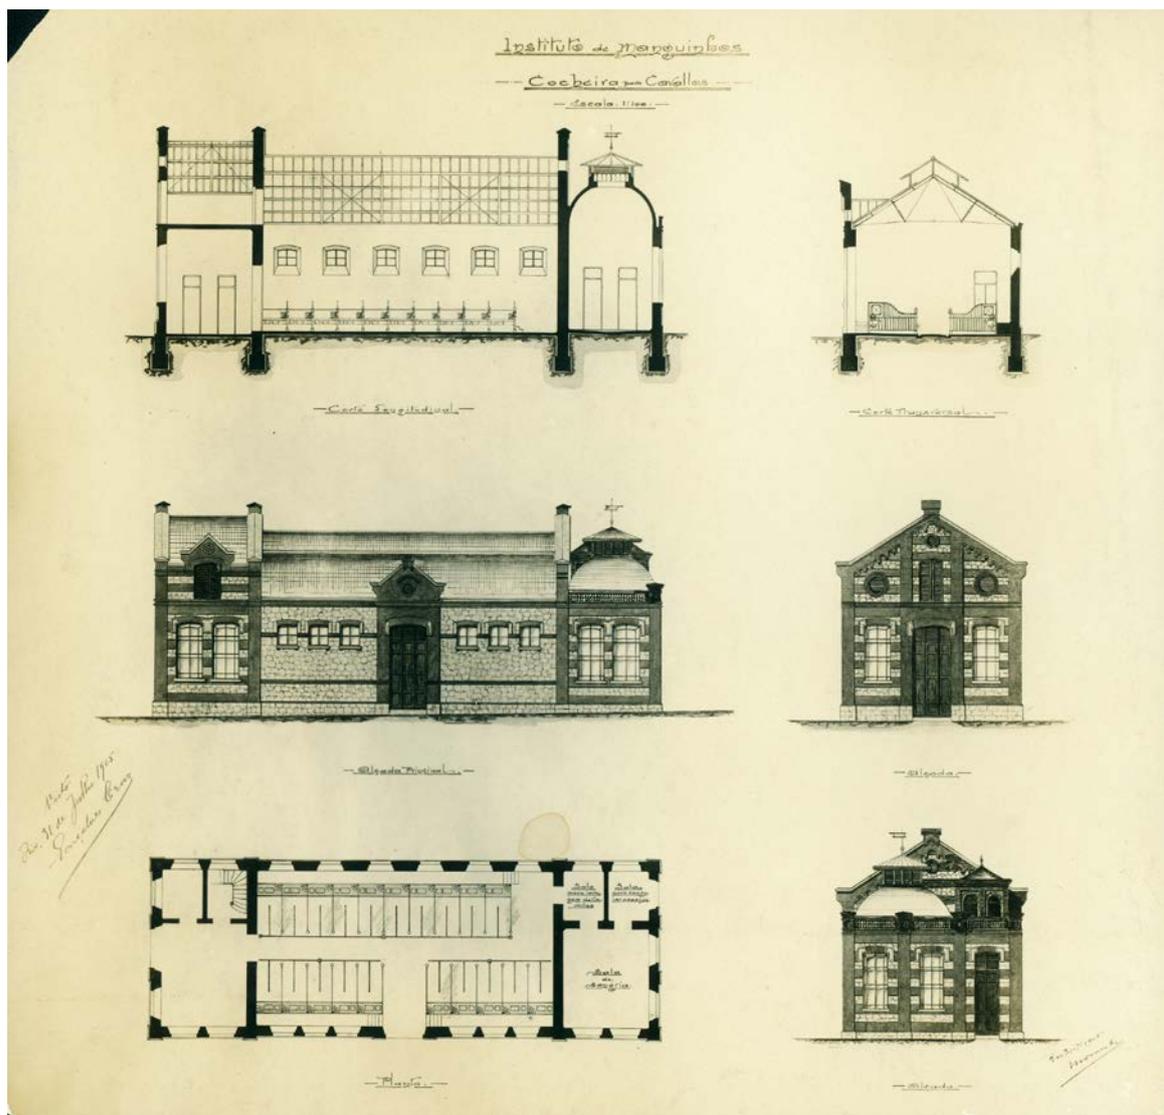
Planta baixa, fachadas e cortes da cavalariça
